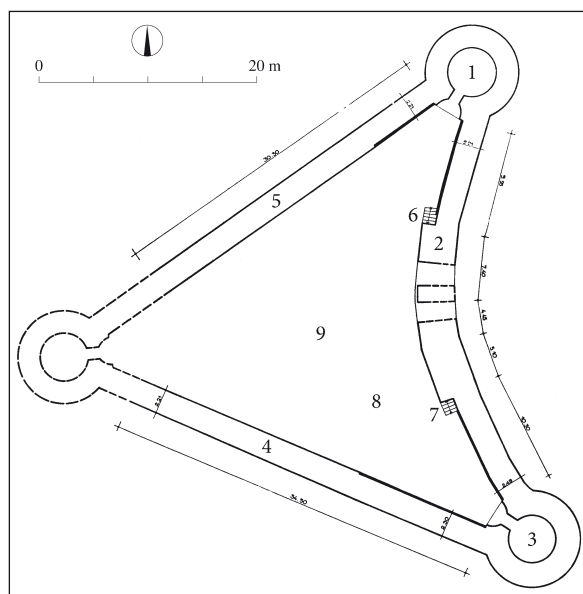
Bosman, Grundriss (nach Kondić 1982–1983, Abb. 1).
